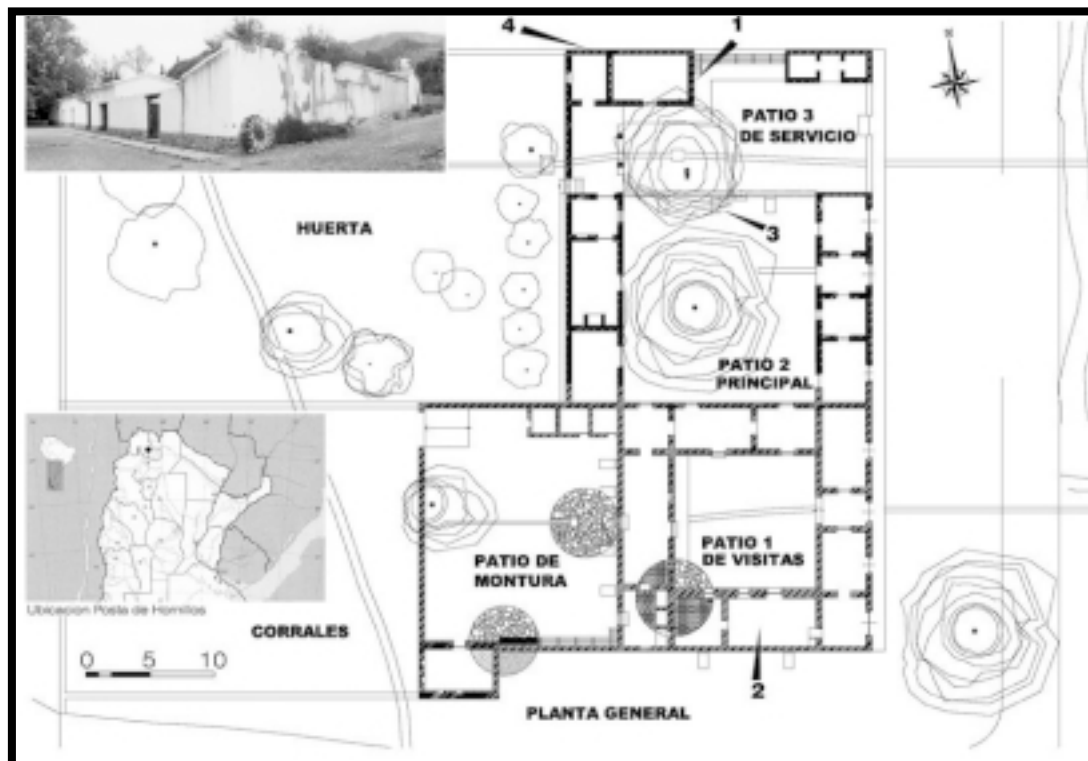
SECTORES ESTUDIADOS EN LA POSTA DE HORNILLOS: 1 MURO ESTE; 2 CUBIERTA PATIO 1; 3 MURO NORTE PATIO 2; 4 MURO NORTE EXTERIOR.
